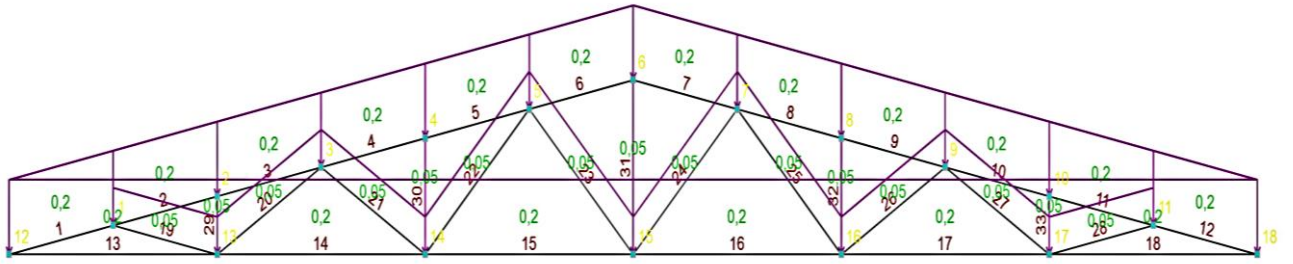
Загрузка №1 «Собственный вес стропильной фермы»
